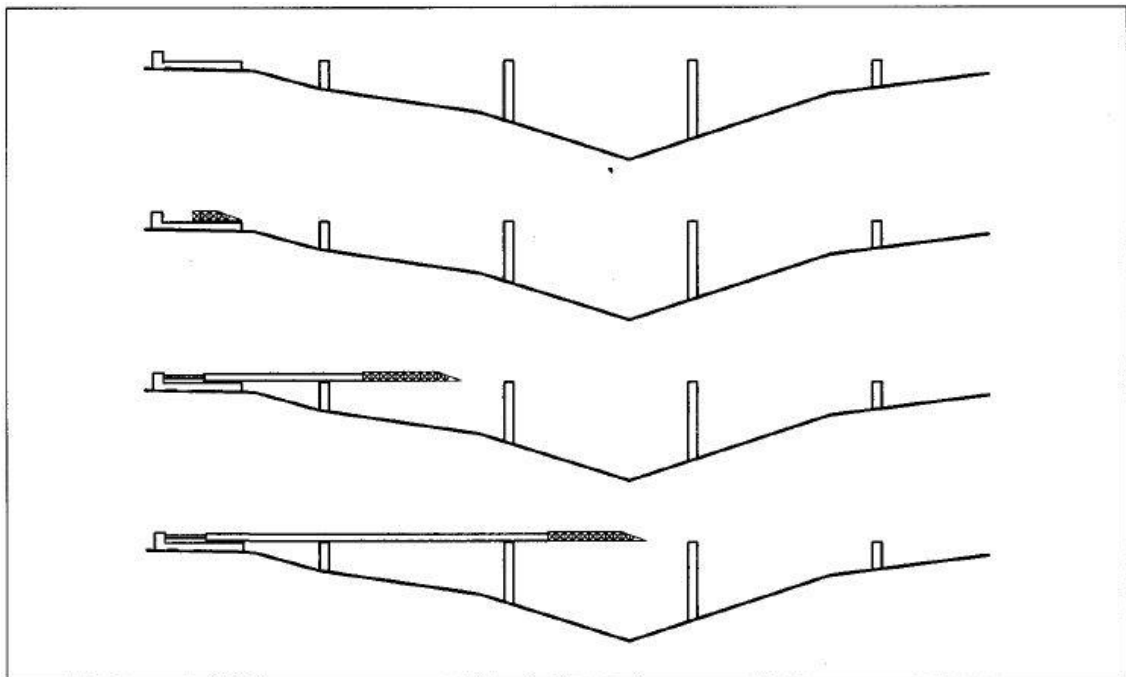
Esquema de la construcción por empuje del dintel. Fuente: Obras de paso de nueva construcción. Conceptos generales. Figura 14.
